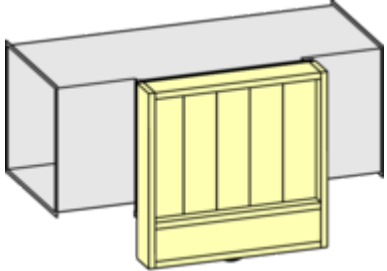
Detail C, Anschluss Stahl-Entrauchungsleitung, (gezeichnet ohne Dämmung)
